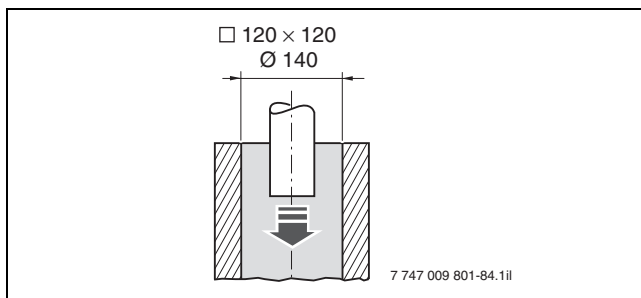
Mindestmaße des Schachtquerschnitts für die Montage der Abgasleitung aus dem Bausatz GA-K für U152 (Maße in mm)
